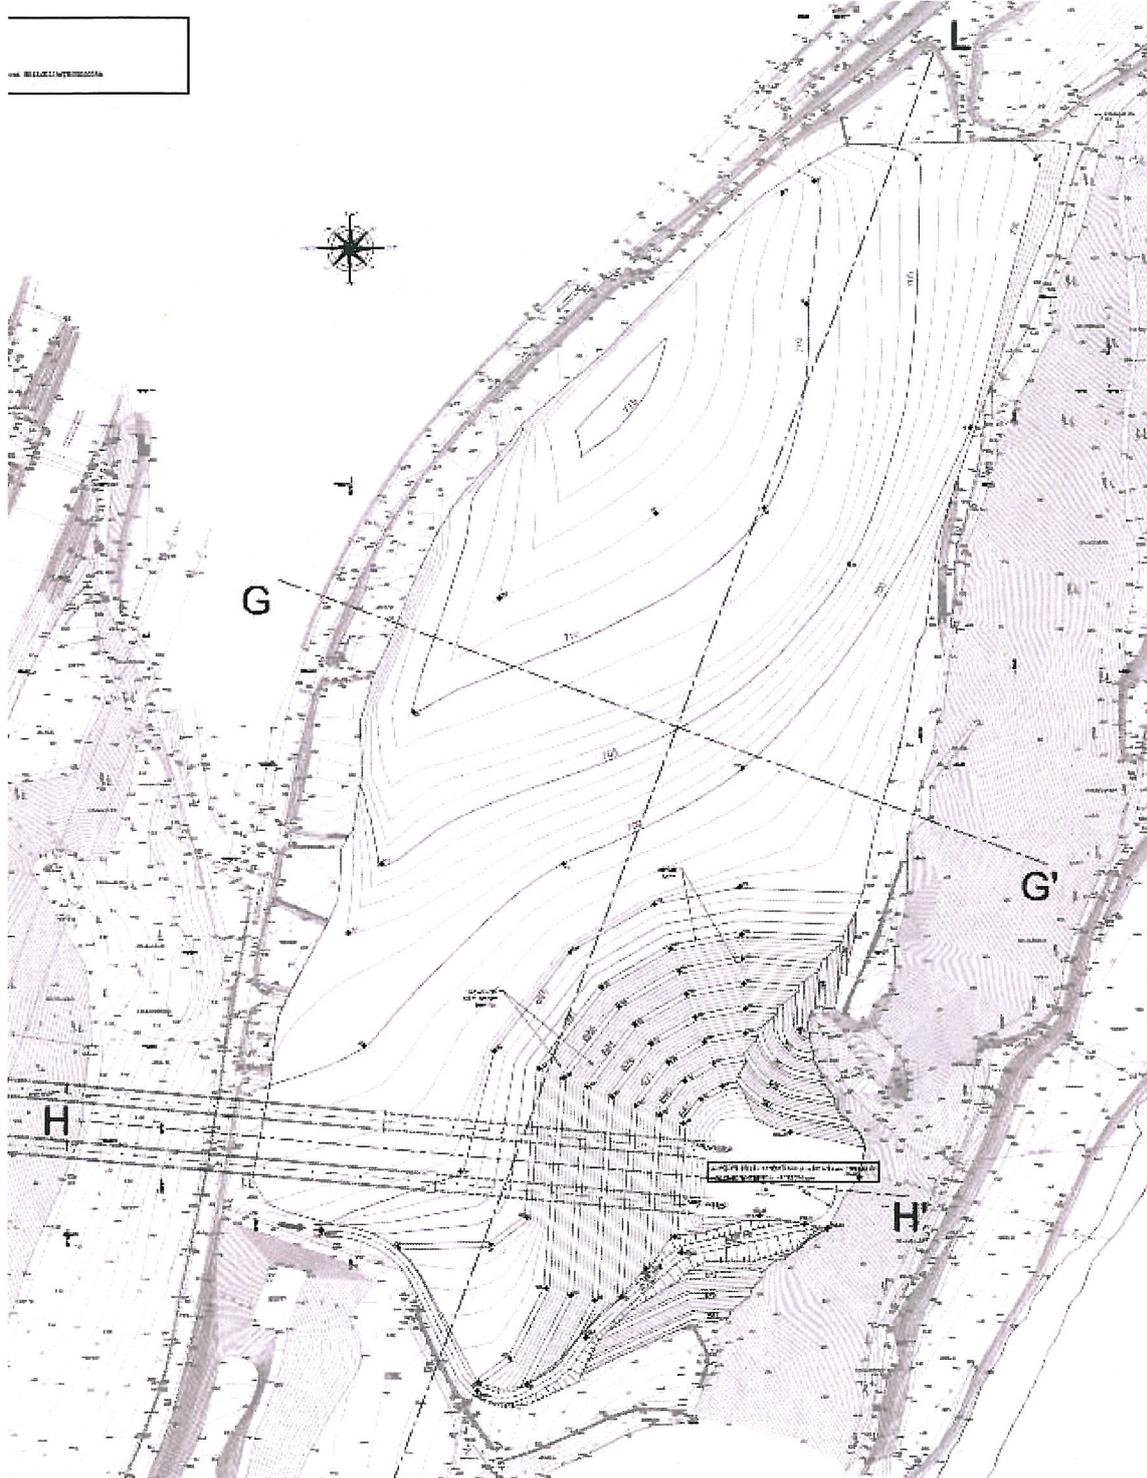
Depositi definitivi in Val Riga – Forch – Planimetria di progetto
